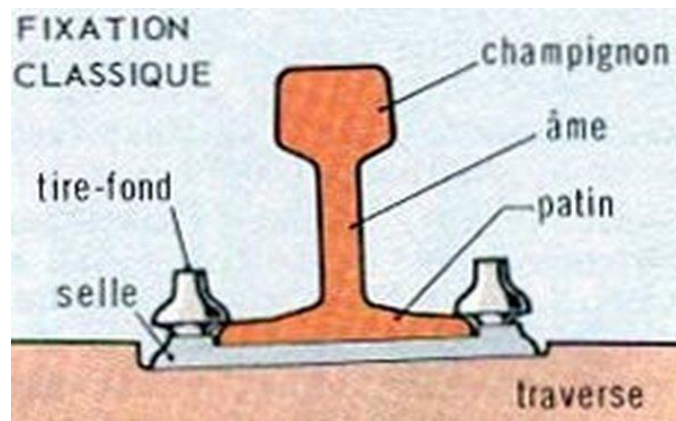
Fixation du rail Vignole sur traverse en bois.
